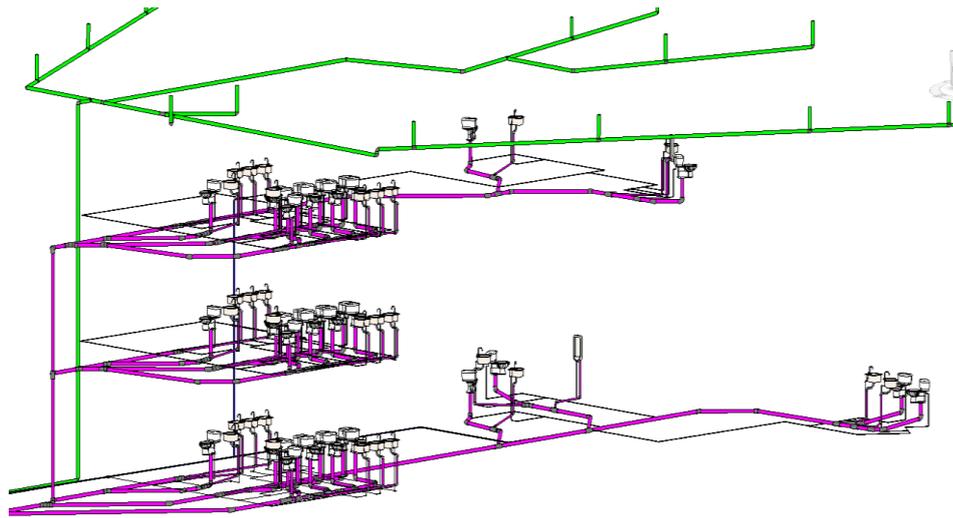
PLANO DE AA.SS. Y AA.LL. 3D.
